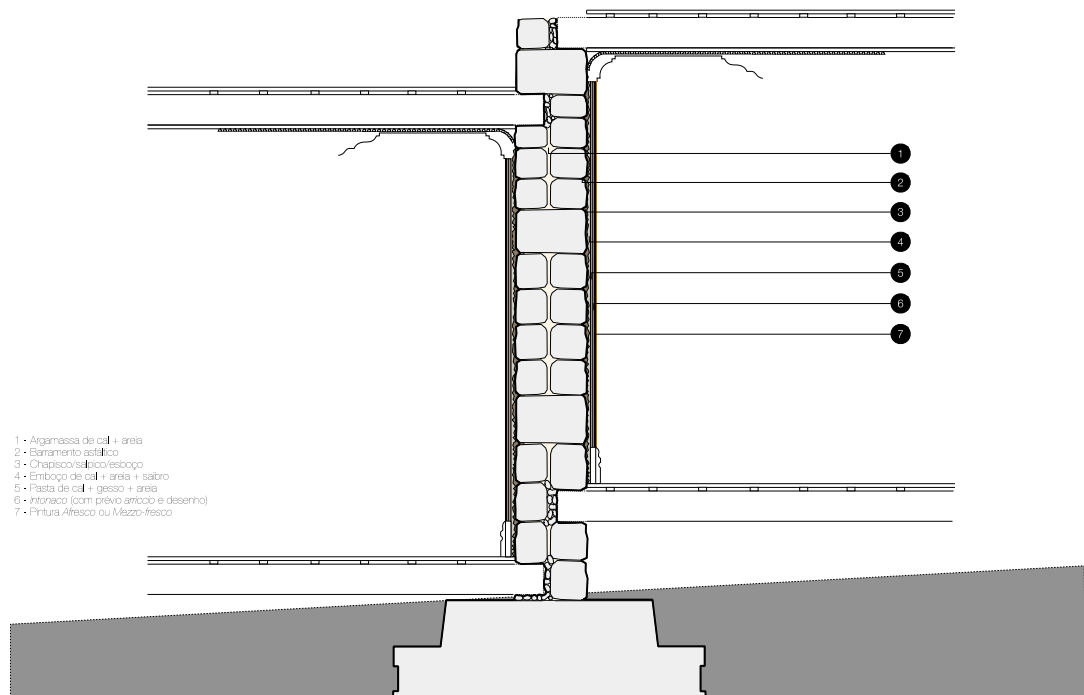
Construção de paredes meeiras com apoio de sobrados.
